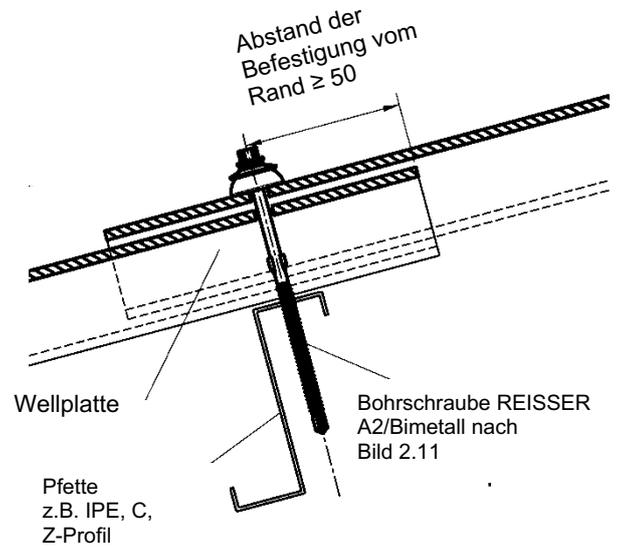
Anordnung der Befestigung auf Stahl- und Aluminium-Unterkonstruktionen mit Bohrschrauben
